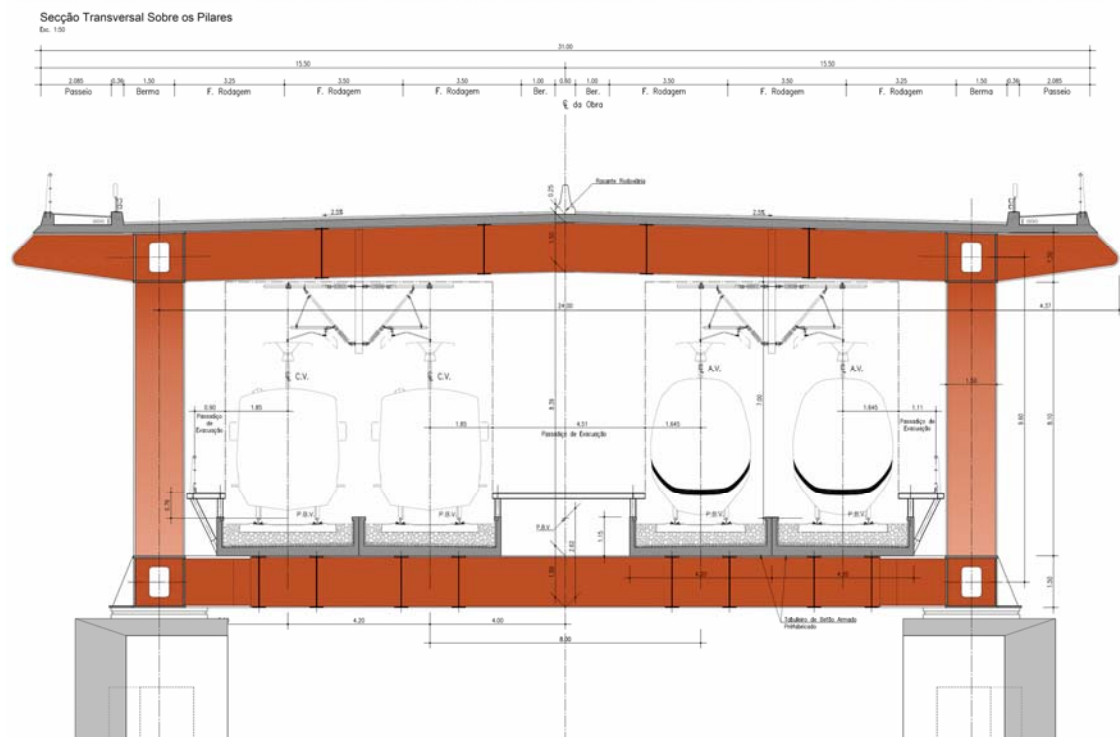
Secção transversal da travessia rodo-ferroviária Chelas-Barreiro (fonte: GRID, 2008)
